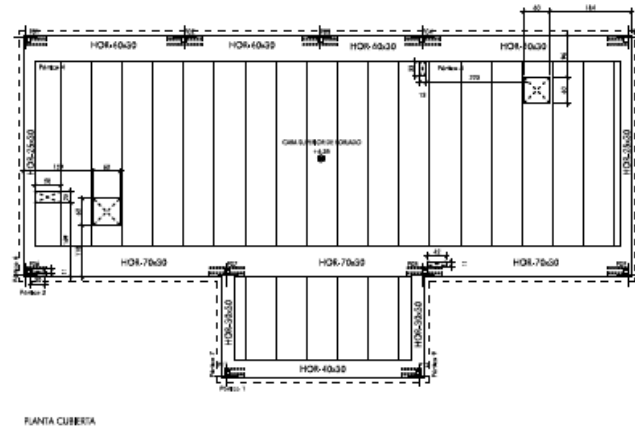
Plano de forjado de cubierta. Fuente: Arhotek
